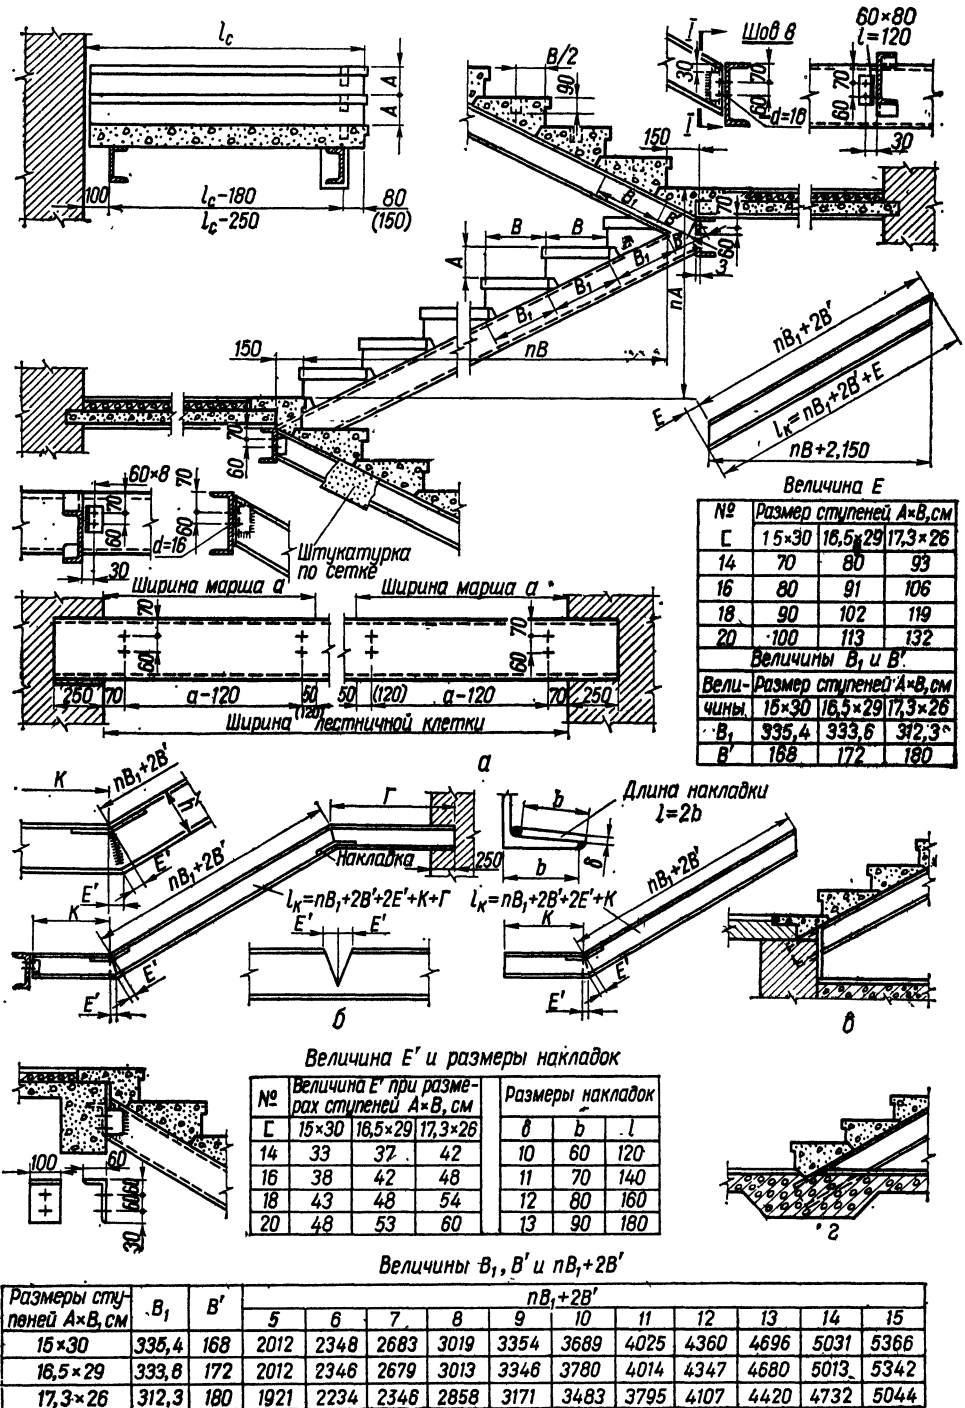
Двухмаршевая лестница с металлическими косоурами и лобовыми балками
